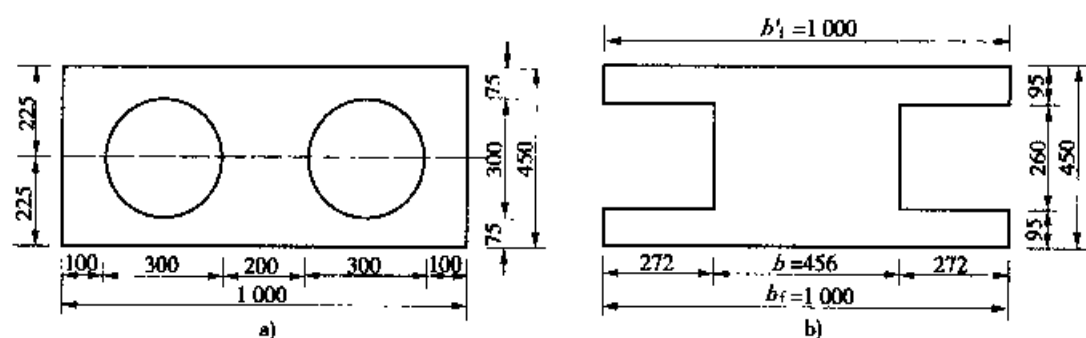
钢筋混凝土空心板截面尺寸(尺寸单位:mm)
